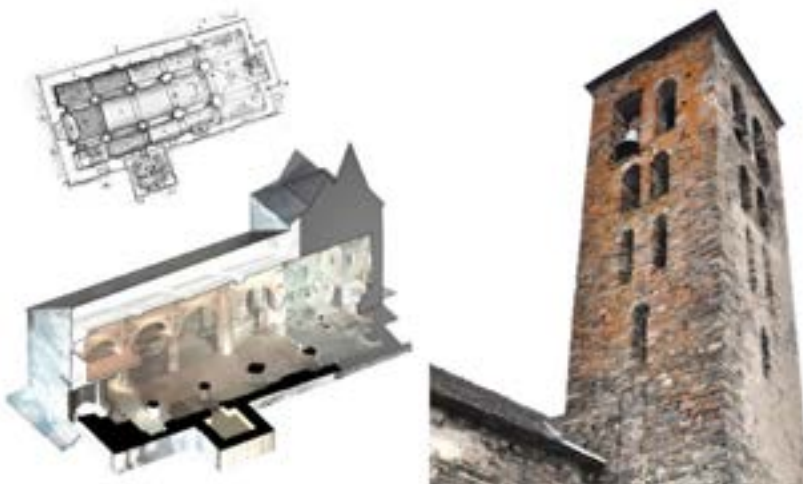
Campanau façada Sud de Santa Maria de Vilamós [12]
